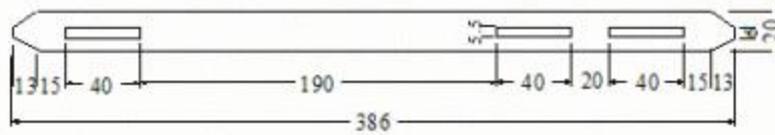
Coupe horizontale sur mur enterré avec VERTICAL BLOC de 20 cm
